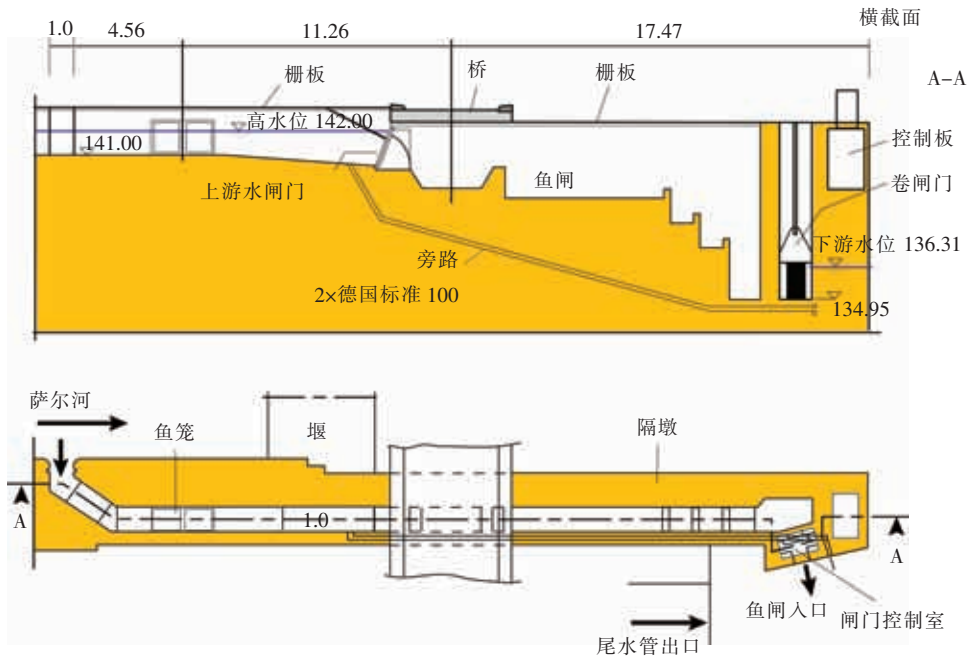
舍登鱼闸（萨尔河）的纵截面图和平面图
